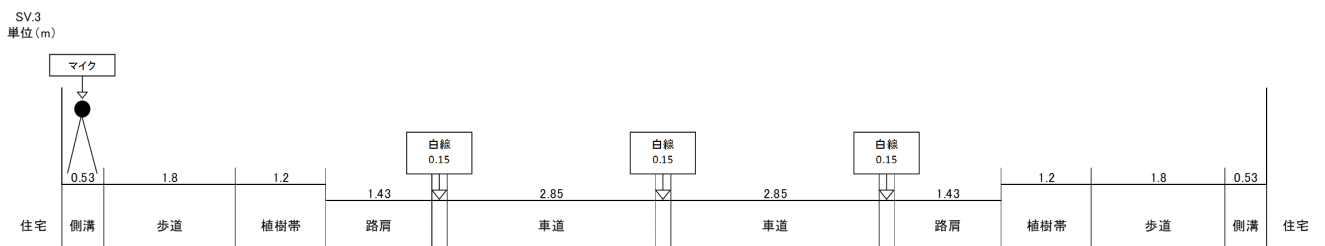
(1) 道路構造断面図 (SV.3)
